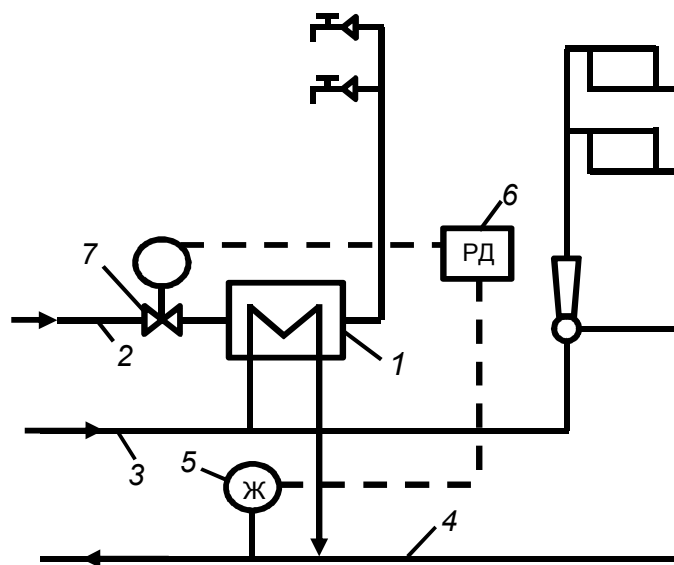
Принципиальная схема теплового пункта закрытой системы теплоснабжения: 1– подогреватель горячего водоснабжения; 2– трубопровод водопроводной воды; 3– подающий трубопровод сетевой воды; 4– трубопровод обратной сетевой воды; 5 – датчик жесткости воды; 6 – регулятор давления; 7 – регулирующий орган; 8 – регулятор давления «до себя»
